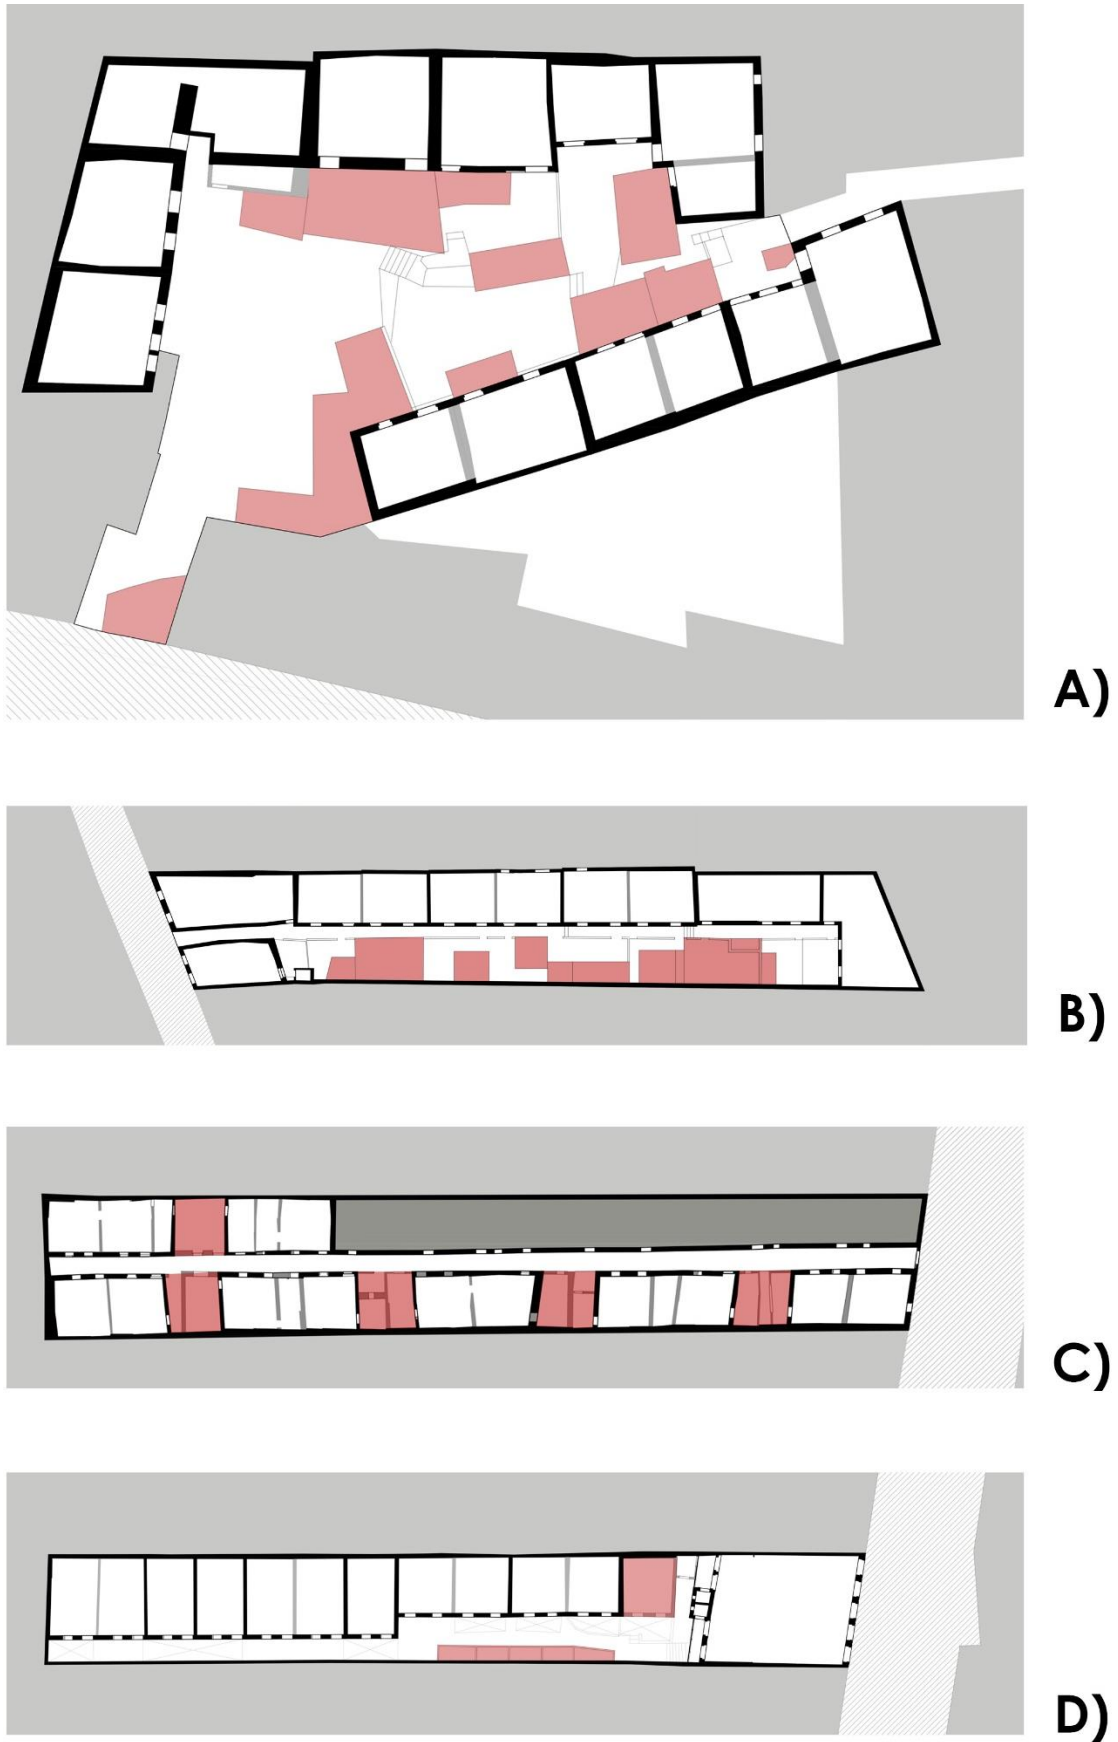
Esquema de ocupação em planta: existente, proposto e demolições (a vermelho) (fonte: autores).
